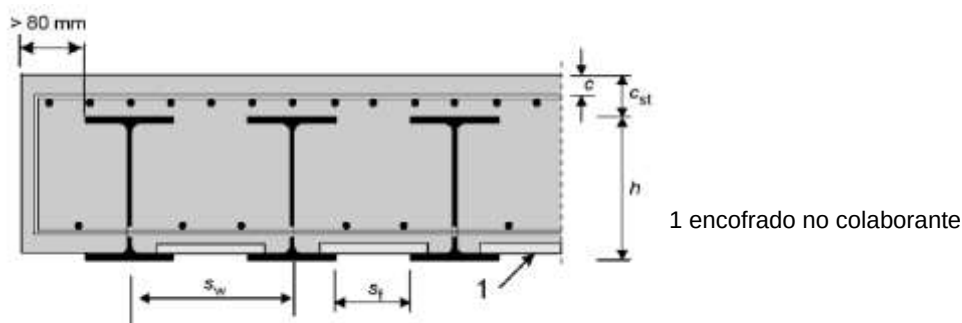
Sección transversal típica de un tablero con vigas de acero embebidas
